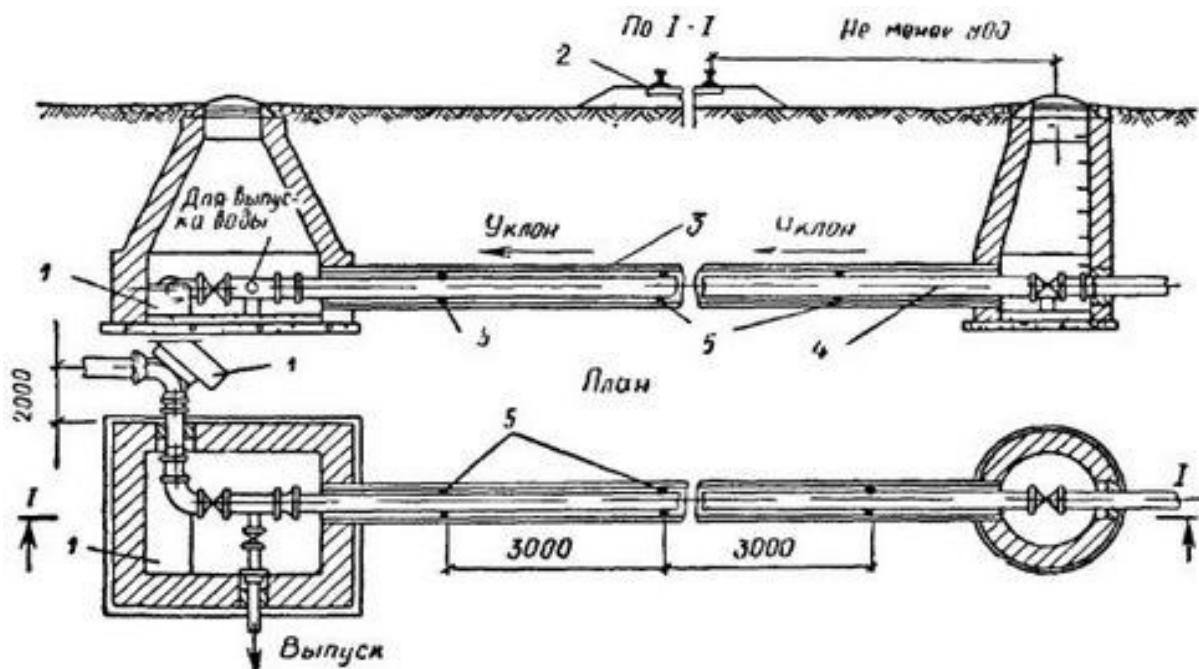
Устройство для перехода трубопровода под железнодорожными путями: 1- упор; 2- железнодорожный путь; 3- кожух (футляр) из стальных труб; 5- стальная труба; 4- опоры для труб.
